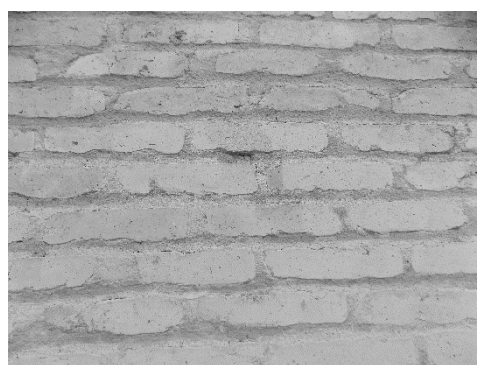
Apariencia del muro de rejola de la casa de Montemuzo tras restauración. Fuente elaboración propia.
